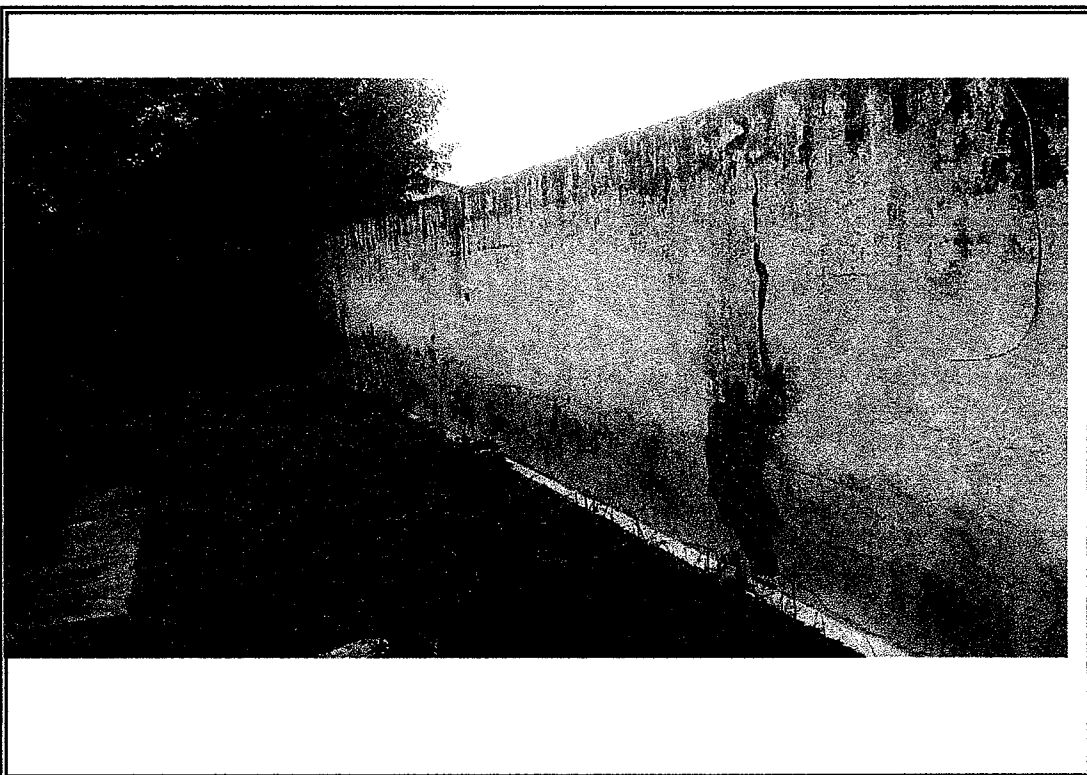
Vista do muro, que ao fundo será construído estrutura e telhado para garagem.
